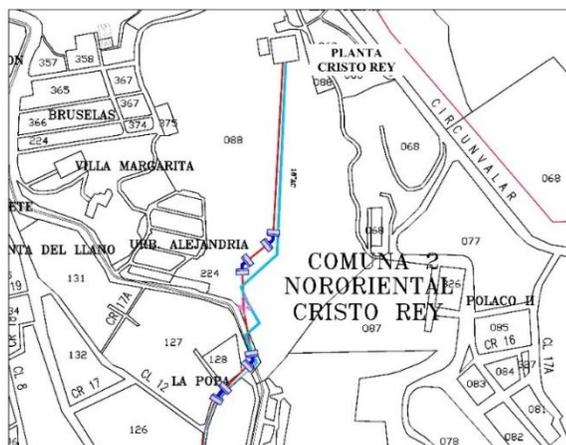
Corrección del trazado zona la Popa. Fuente: Pasante del proyecto.
